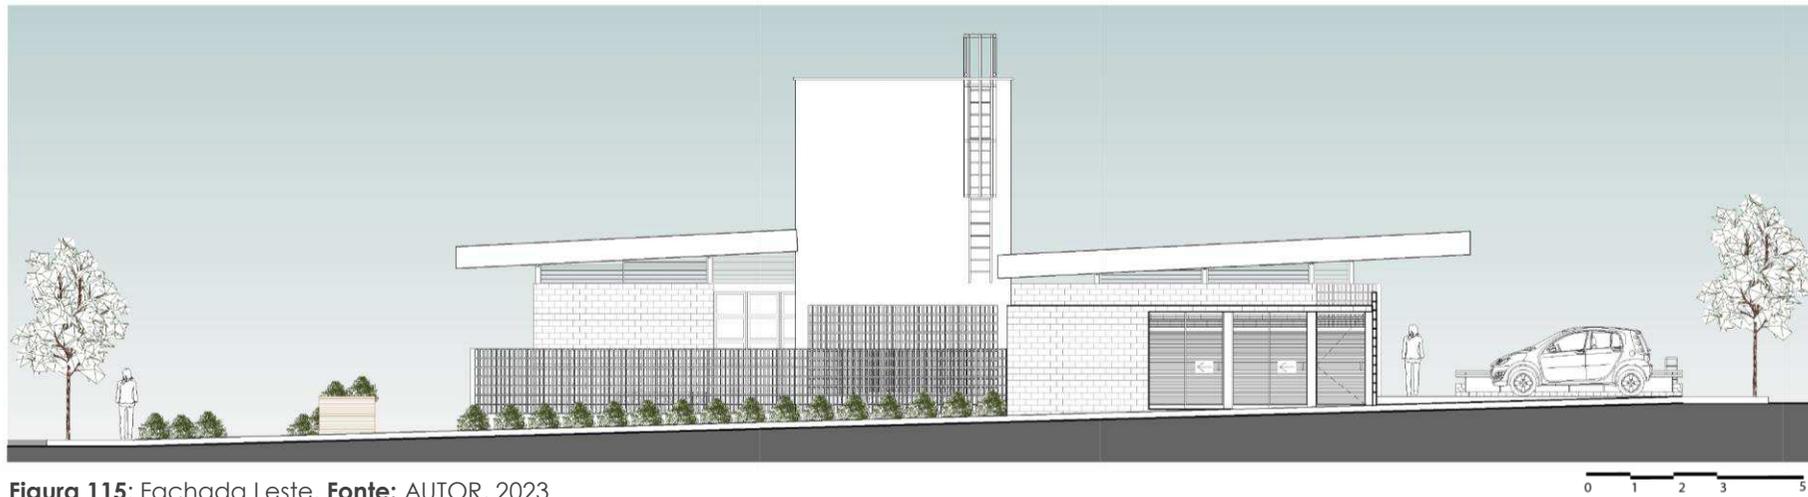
Fachada Leste. Fonte: AUTOR, 2023
